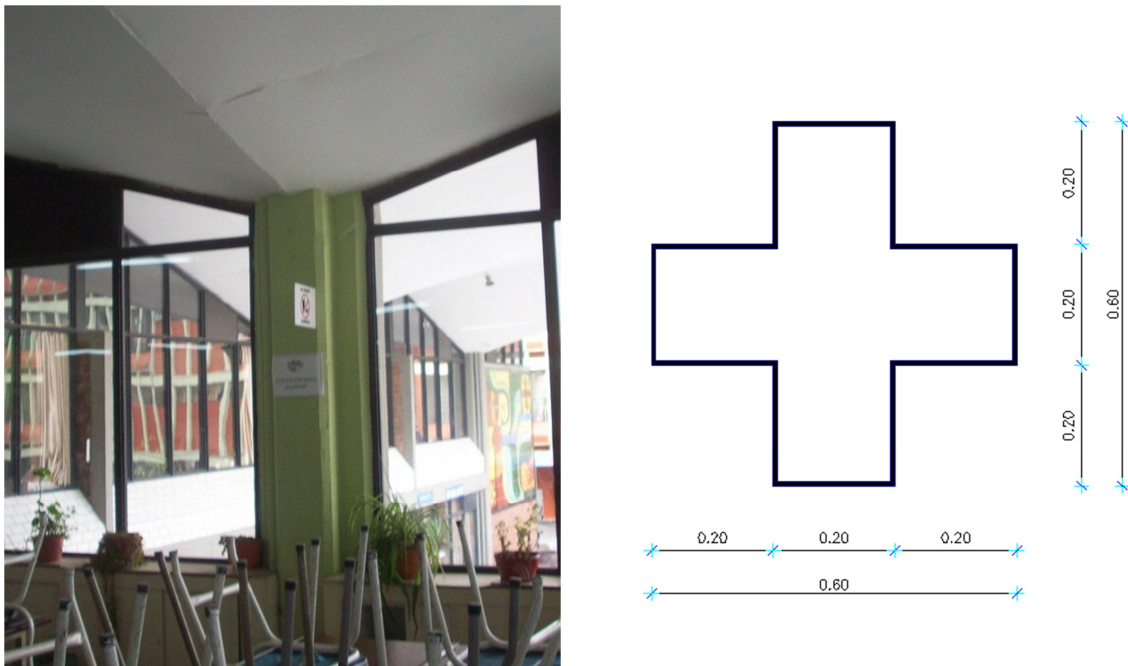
Estructura columna-cubierta y detalle columna cruz en planta
